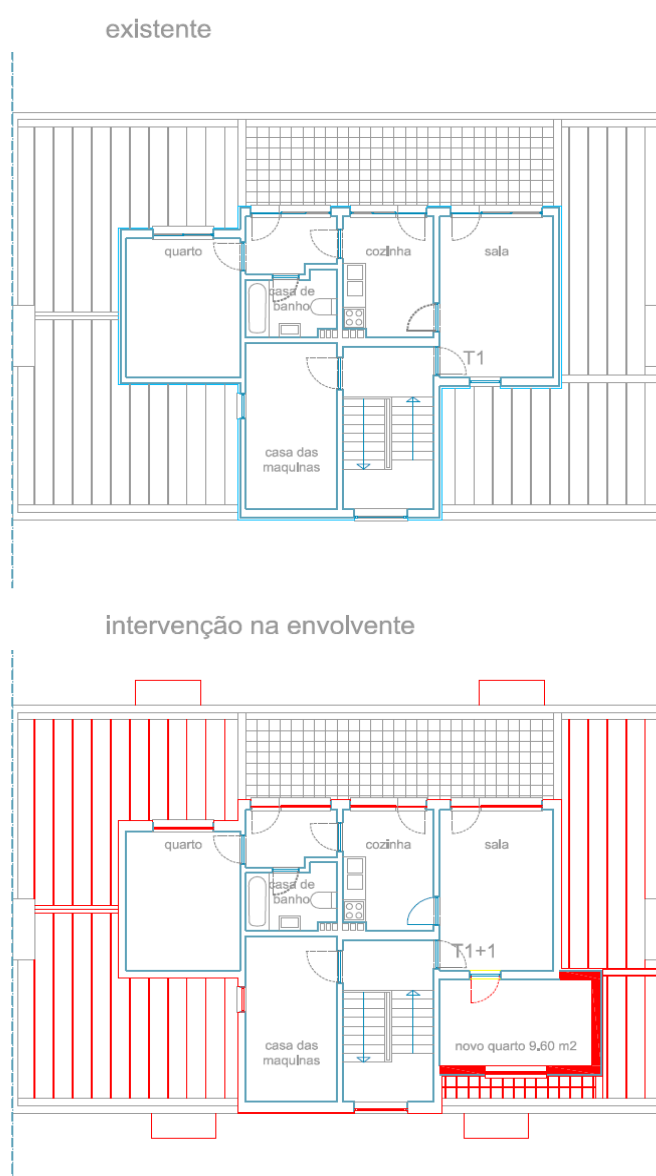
Tipologia “plana”. Planta do terraço (escala 1/200).
